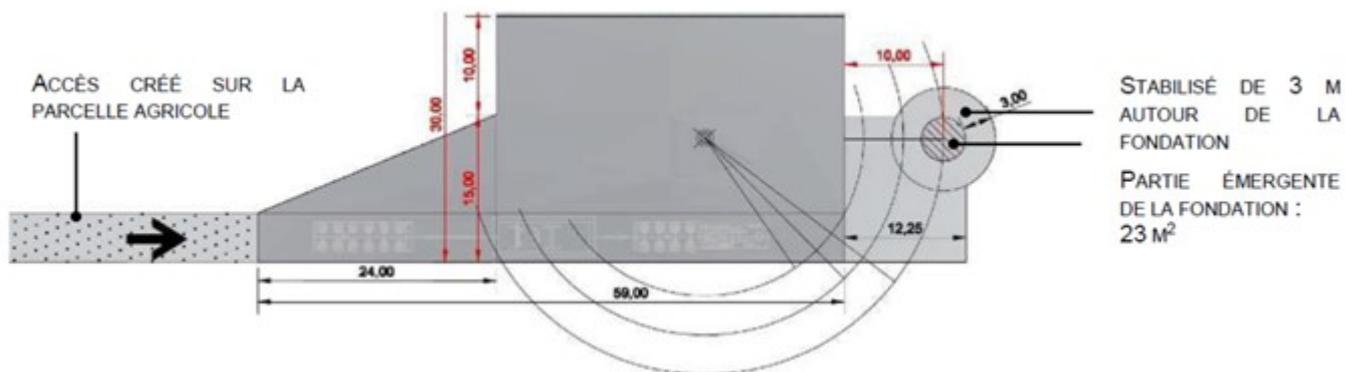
SCHEMA D'UNE PLATEFORME DE MONTAGE DE V100
